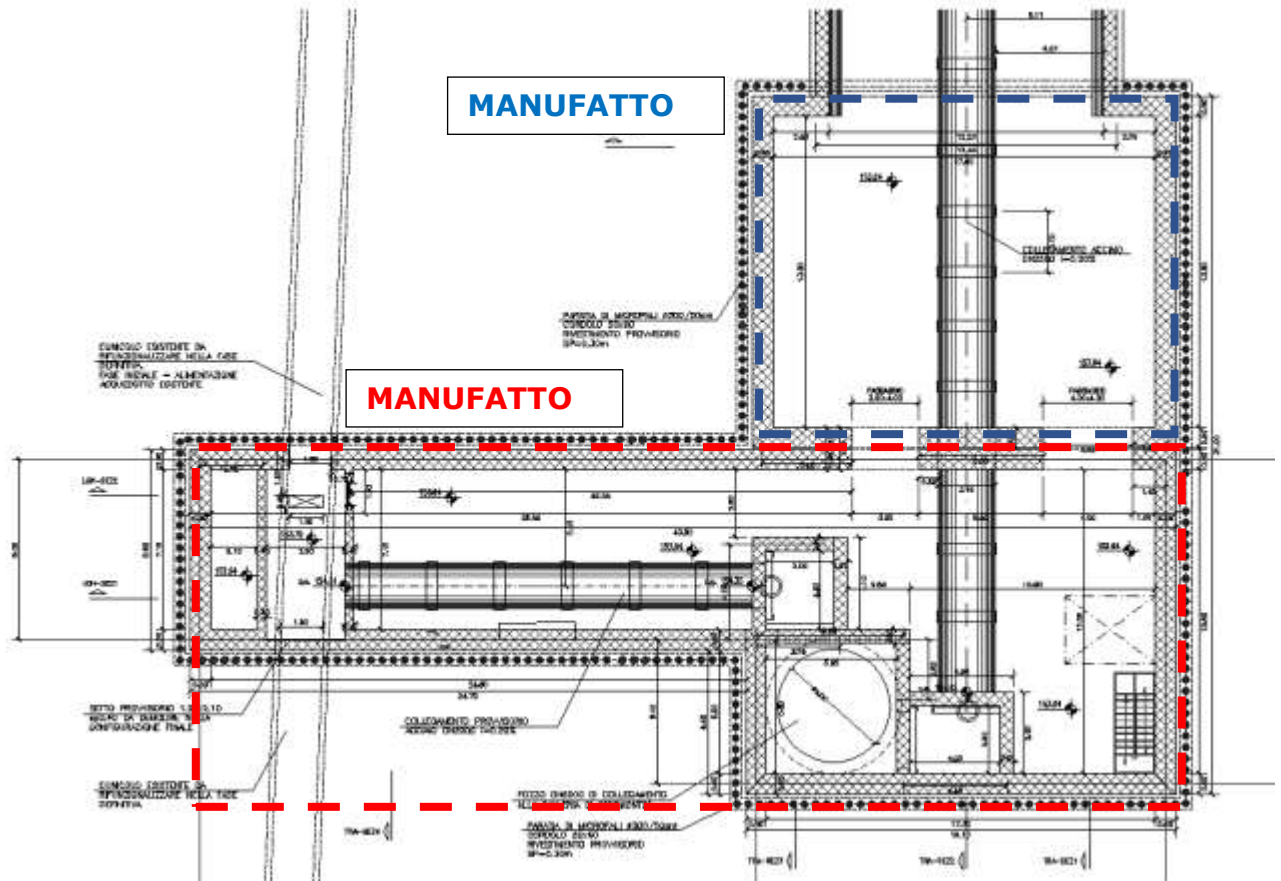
Pianta MANUFATTO 1 e MANUFATTO 2
